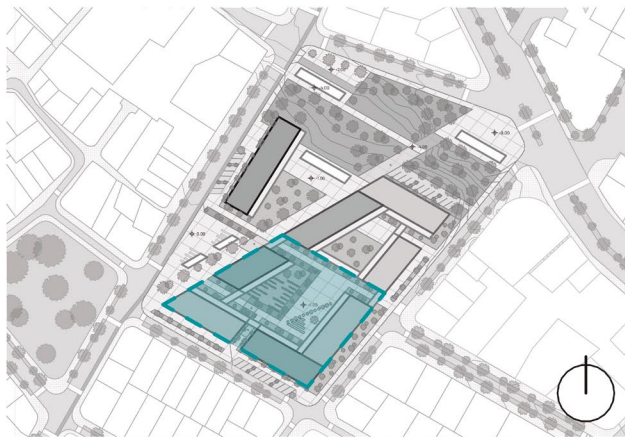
| Planta Cubiertas I Fuente: Autoría propia. (2023).
